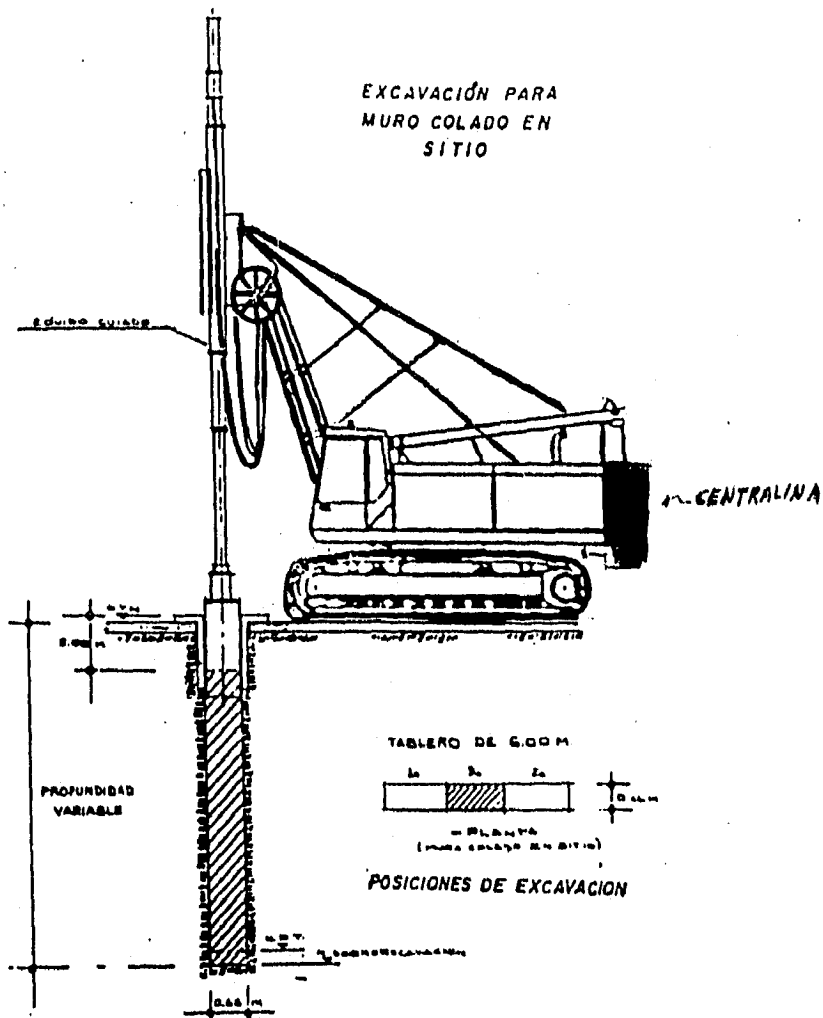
INICIO DE LA EXCAVACIÓN Y SU SECUENCIA DE ATAQUE.
